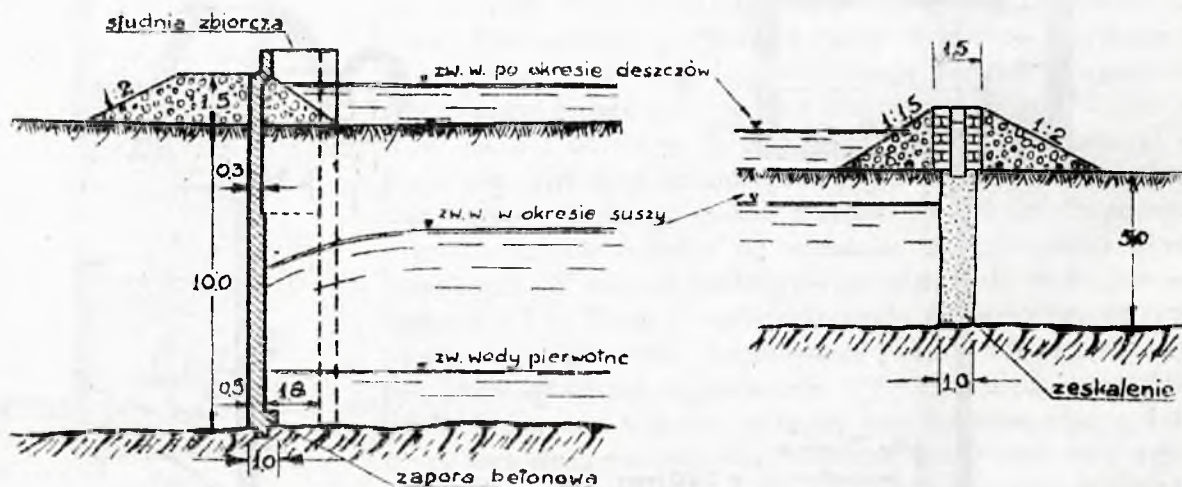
Studnie chłonne (infiltracyjne) na ujęciu Ackerföhre.
